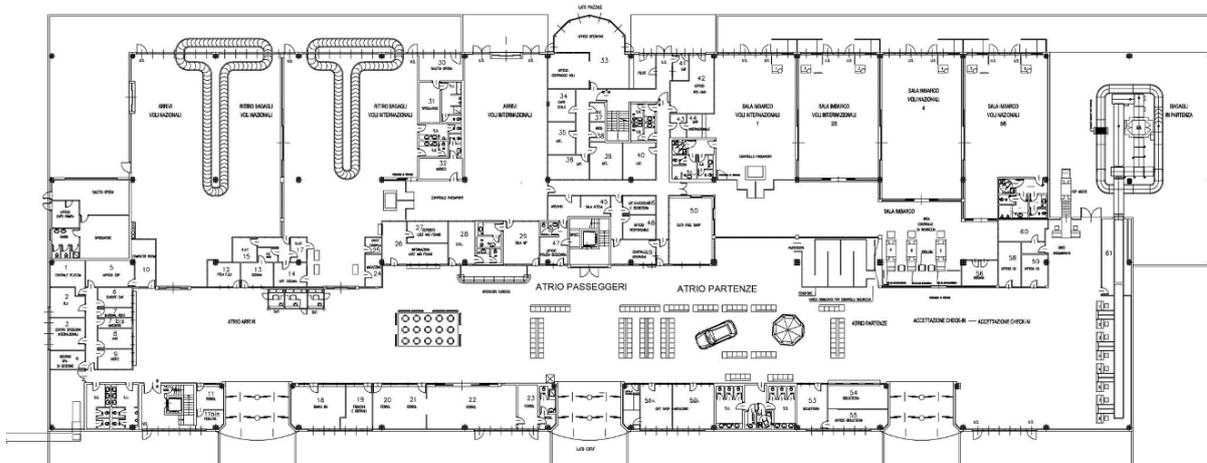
Pianta Piano Primo e Mezzanino
